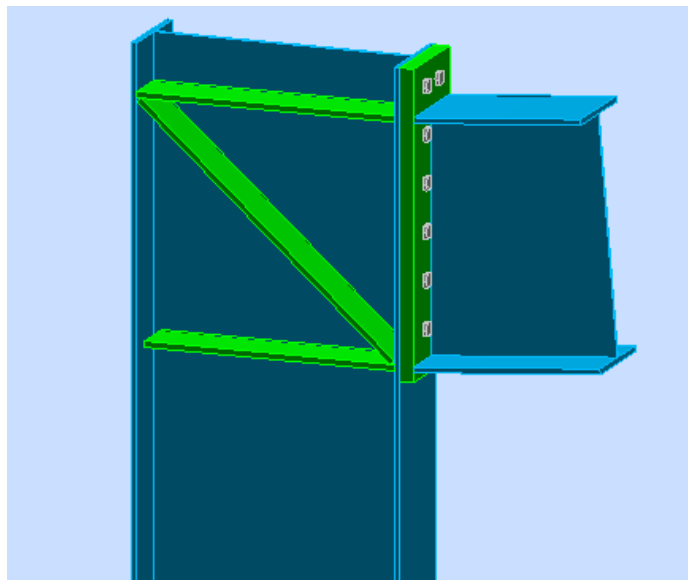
Assemblage poteau-traverse avec un renfort additionnel
